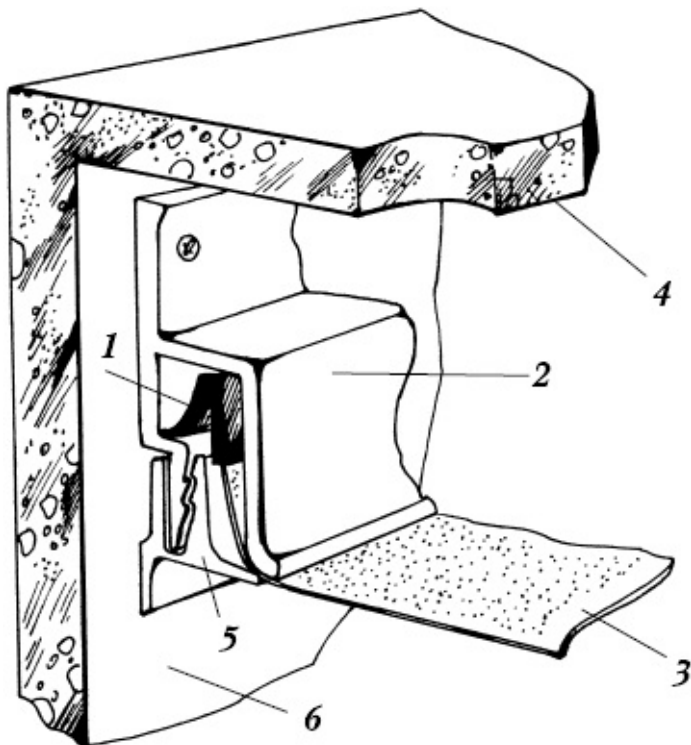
Гарпунный способ крепления натяжного потолка: 1) гарпун; 2) багет; 3) полотно потолка; 4) основной потолок; 5) декоративная накладка; 6) стена
